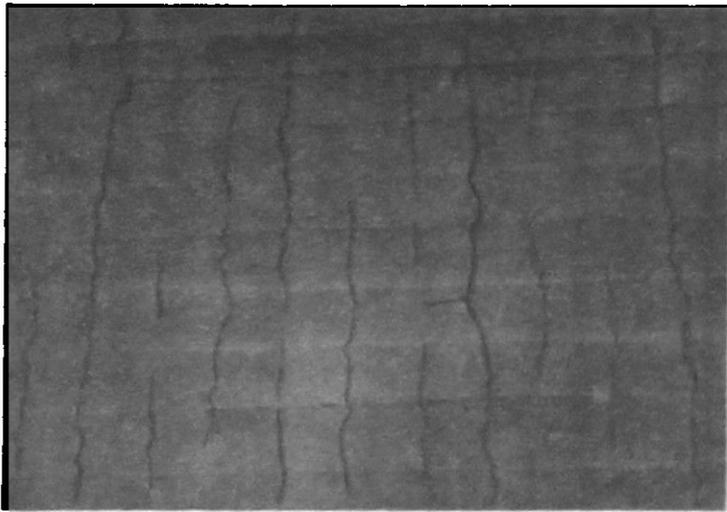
Vista del sistema de grietas generalizadas, en el muro oriente del estribo sur. Las grietas verticales han sido remarcadas; las grietas horizontales no alcanzan a distinguirse.
